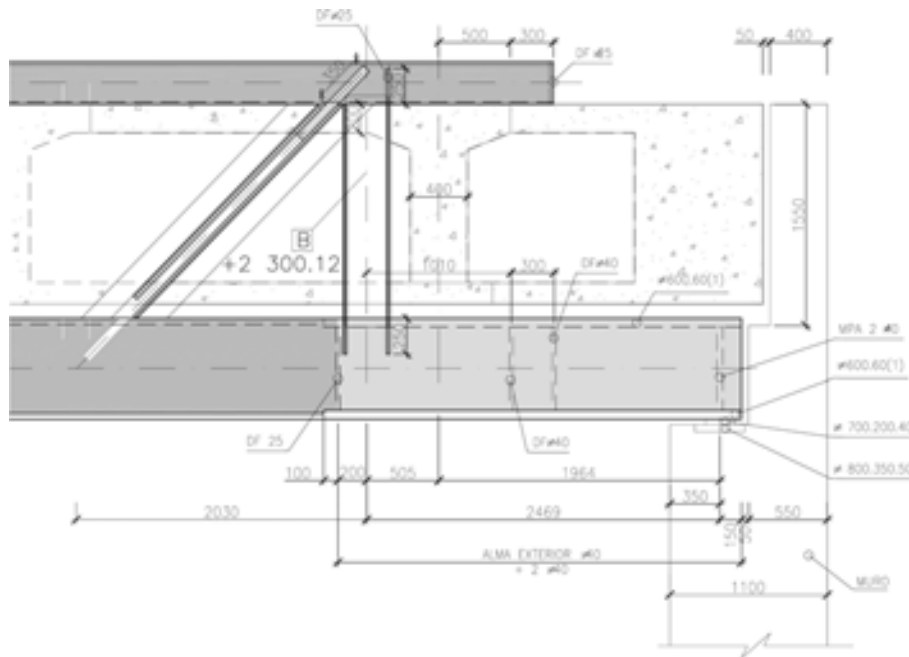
Detalle de apoyo del cordón inferior del dintel en el muro extremo
